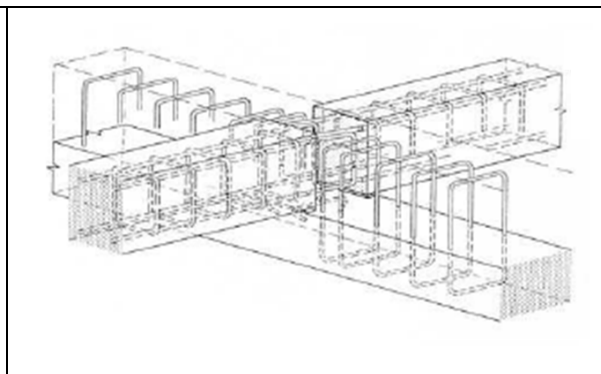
Ligação por betonagem *in situ* do nó (Stupré, 1981)
